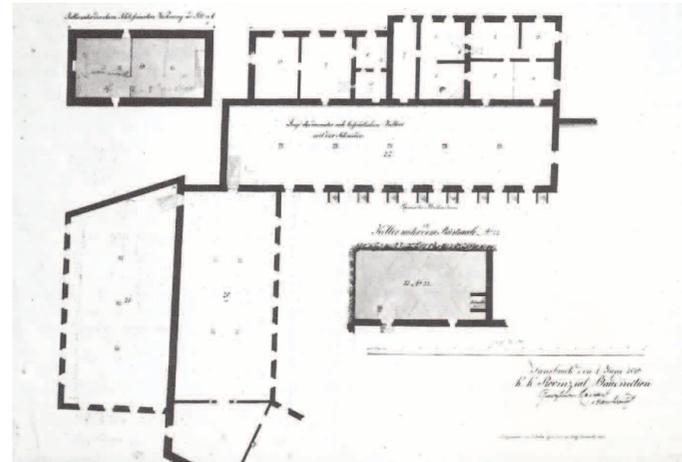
Grundrisse der Museumssäle 4,
